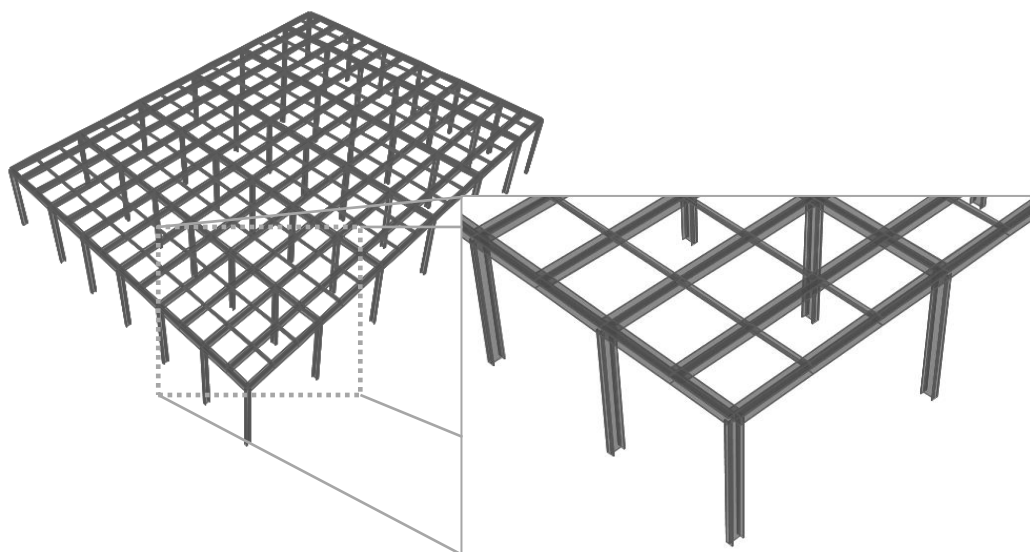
Modelo Extrudido da Estrutura do Piso Metálico
